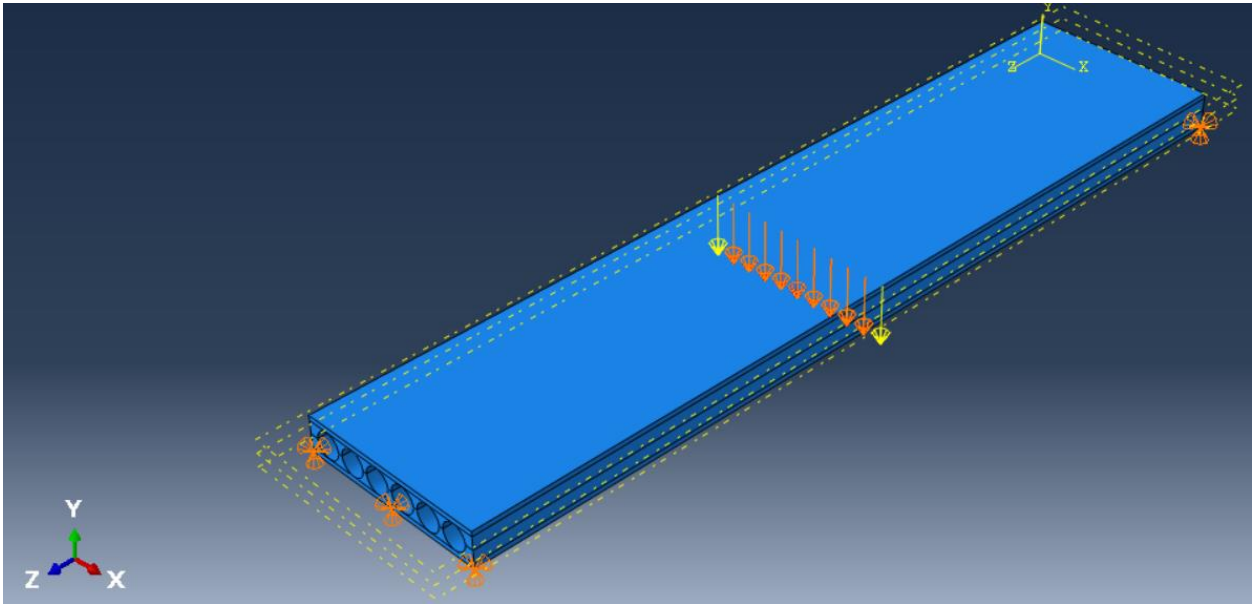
Пустотная плита перекрытий ПКК1 с заданными нагрузками
